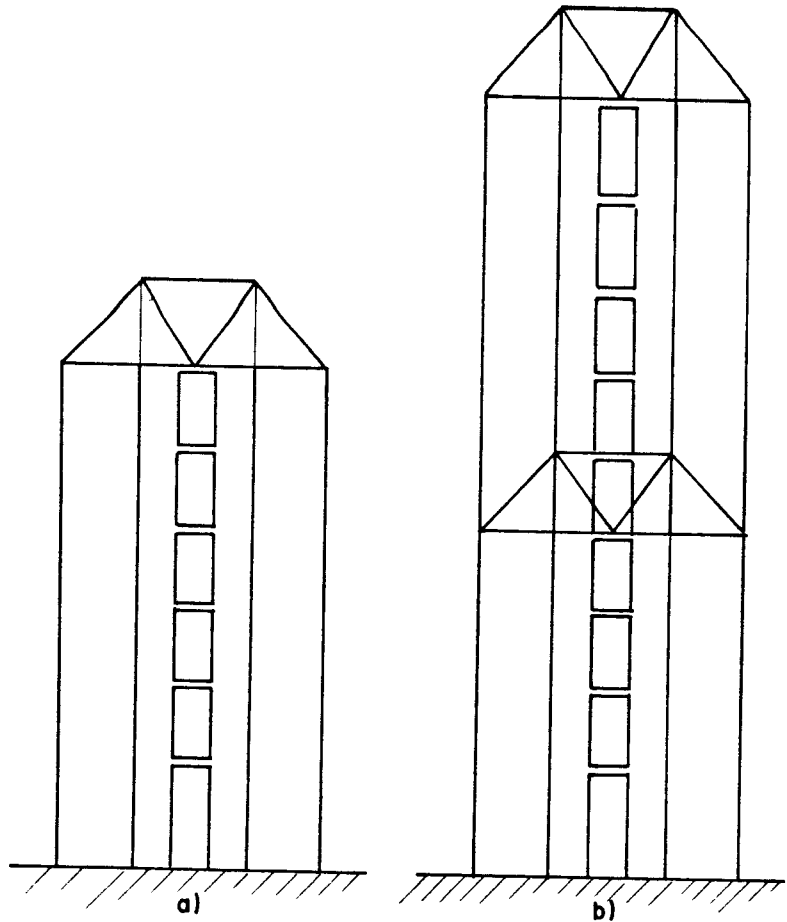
b - TIPOS DE ELEVAÇÃO
